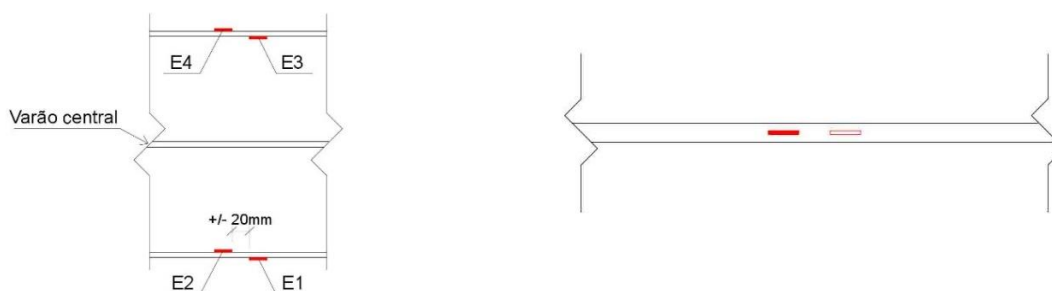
Esquema de localização dos extensómetros, planta à esquerda, alçado à direita
